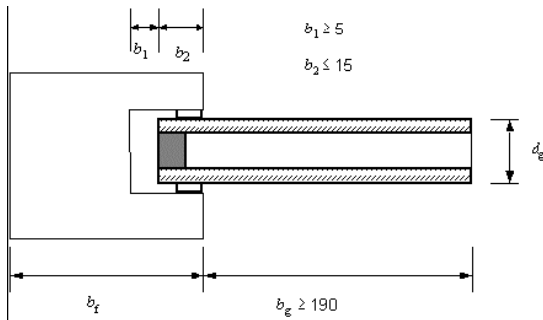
Rahmenprofil mit eingebauter Verglasung
